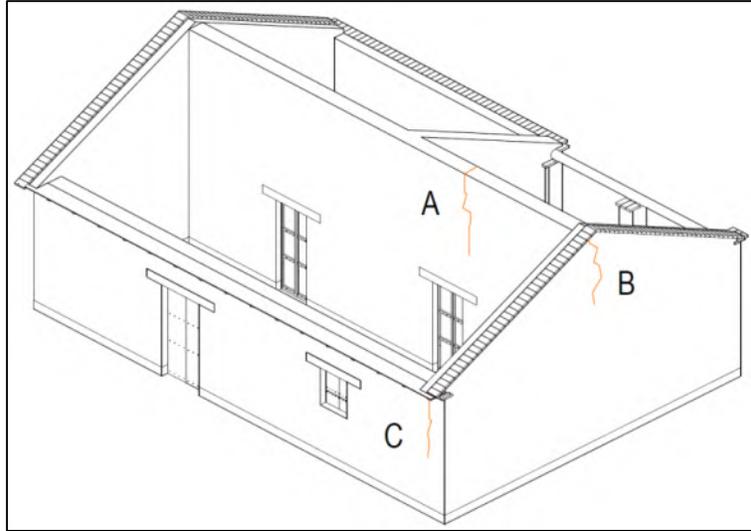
Principales grietas en muros de vivienda de adobe de Santiago Laollaga: A) muro central, B) muro piñón y C) esquina. Fuente: elaboración propia.
